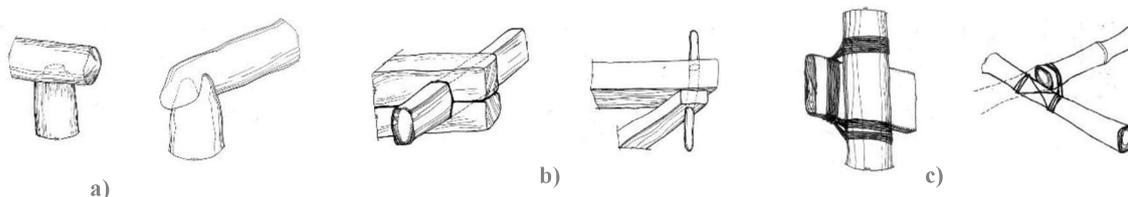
8. Ligações dos elementos estruturais. a) Ligação por entalhe b) Ligação por cavilha c) Ligação por cordame.
